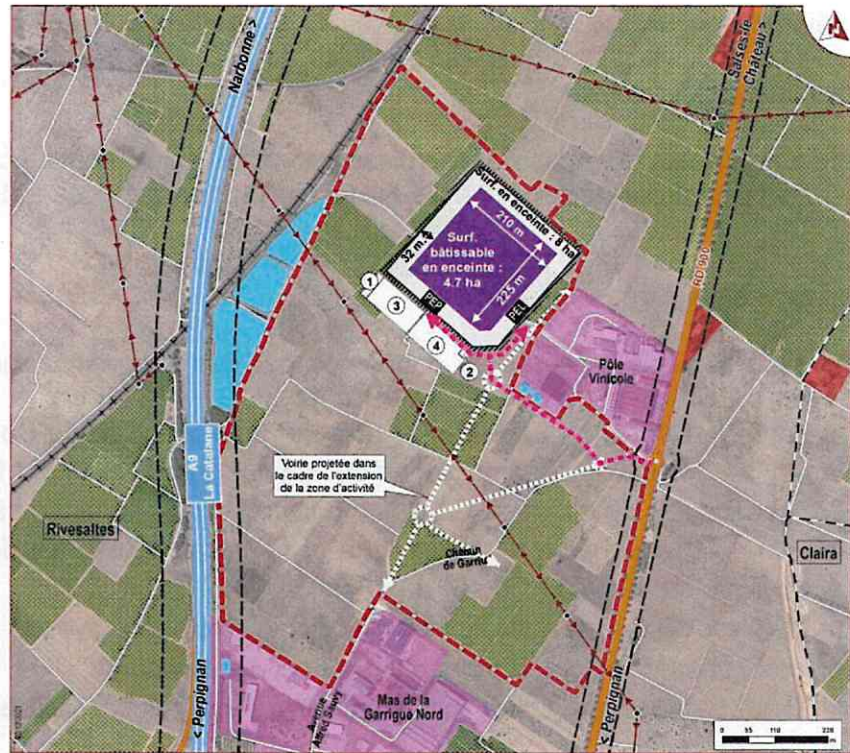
Plan du scénario retenu pour l'implantation du projet (source : page 45 de l'étude d'impact)
